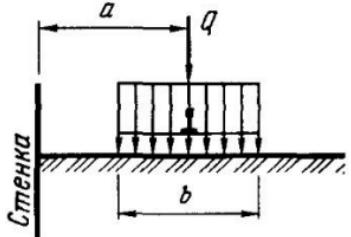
Схема для определения эквивалентной нагрузки от однорельсовой тележки на призме обрушения
